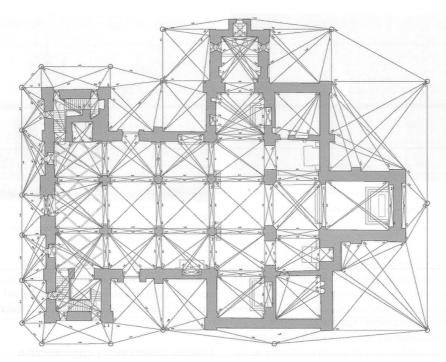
Planimetría, levantamiento efectuado con el método de la trilateracíon (dibujo de los autores 2013)
